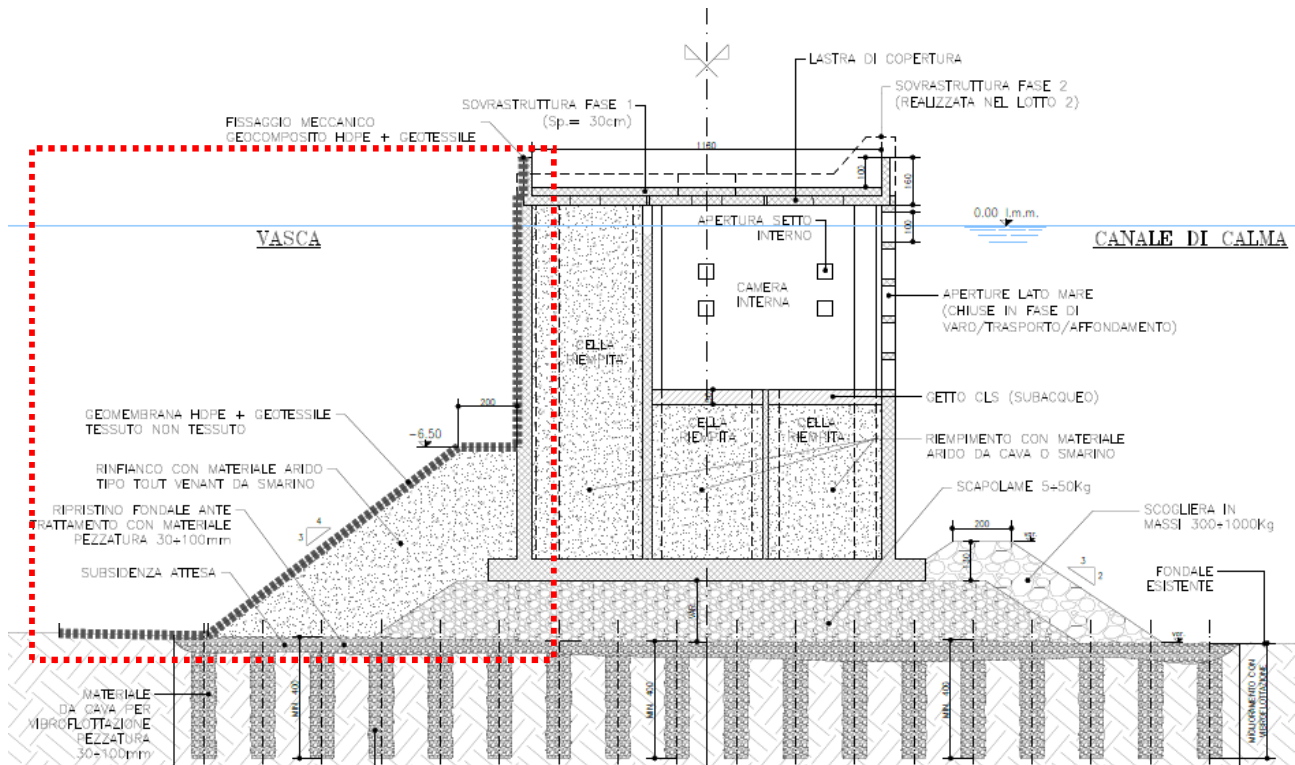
Sezione tipologica cassone con rinfianco e posa geomembrana Progetto Esecutivo
